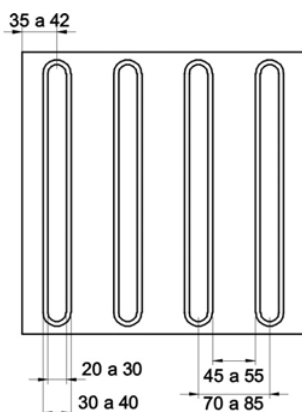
Sinalização tátil de alerta nos rebaixamentos das calçadas – Exemplo
